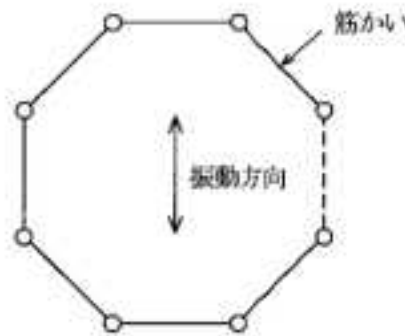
筋かいの配置及び振動方向(平面図)
